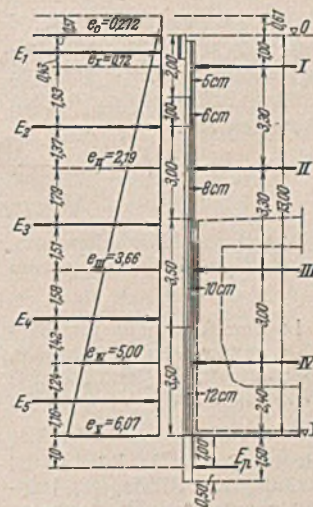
Erddruckbelastung für 1,0 m Baugrubenlänge und Bohlenabmessungen für 2,0 m Rammträgerabstand nach der bisherigen Berechnungsart.
